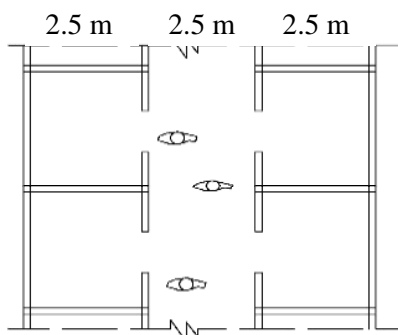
1 Potongan Ruang Pejalan Kaki Typical Zona Perumahan (Kiri)
